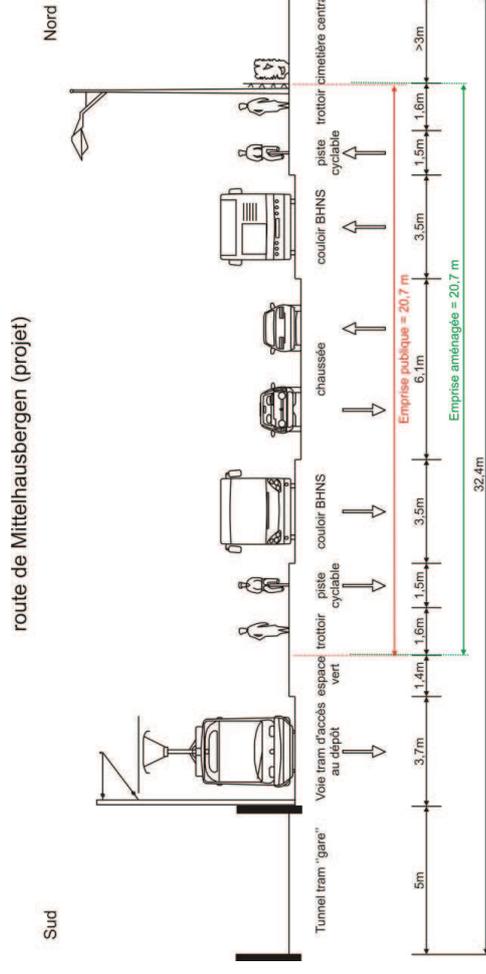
Situation projetée (coupe 34) route de *Mittelhausbergen
